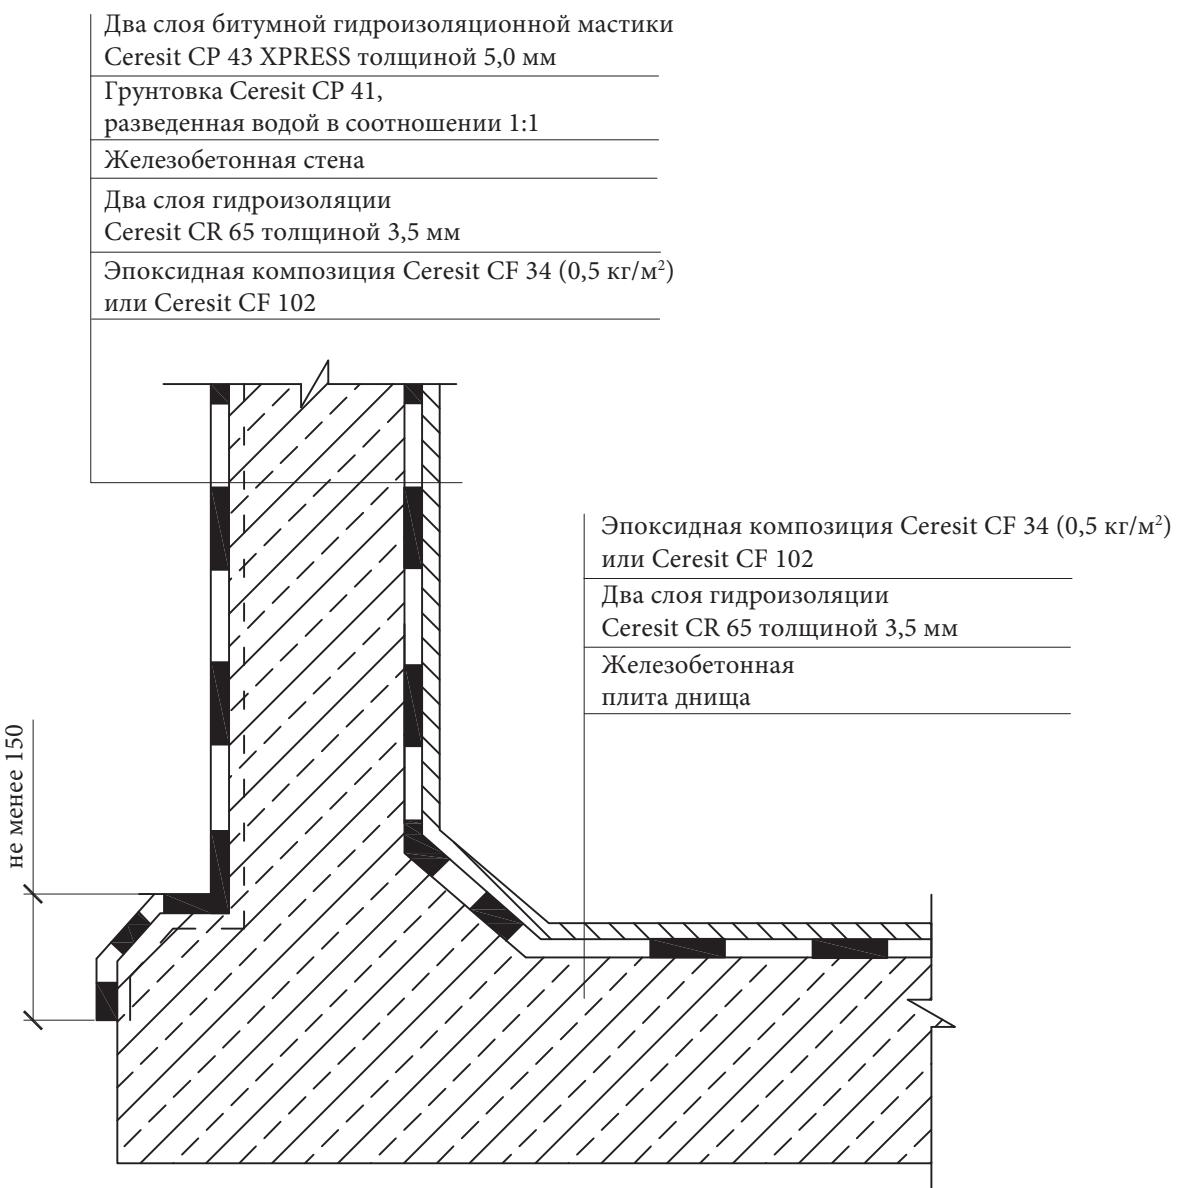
Конструкция системы гидроизоляции бетонных емкостей для сточных вод с повышенным содержанием химически активных веществ с защитным покрытием
